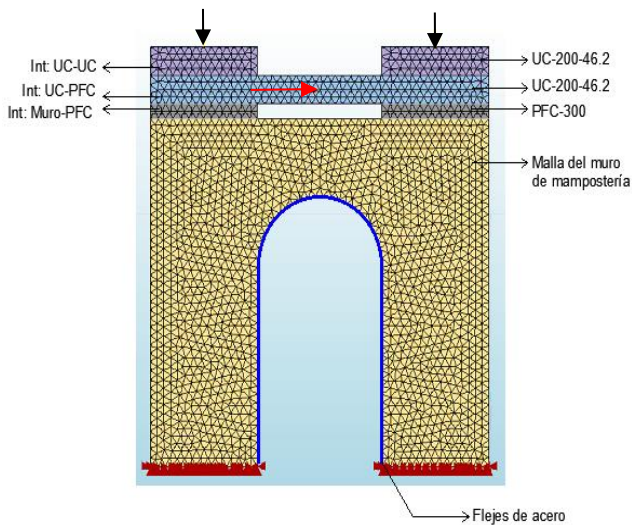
Modelo de mampostería reforzada con flejes de acero.
